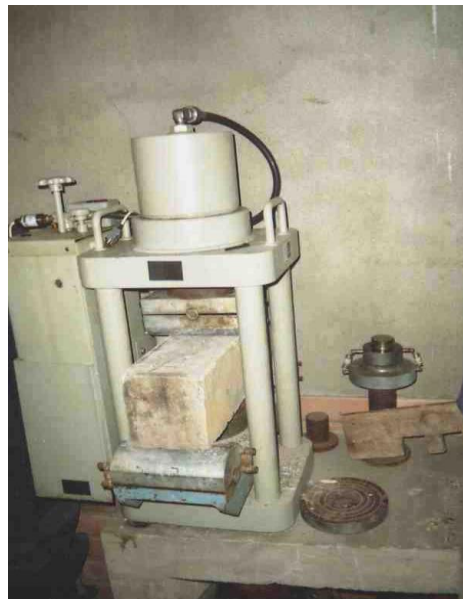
Se muestra el refrentado y rotura de cilindros y vigas de hormigón
